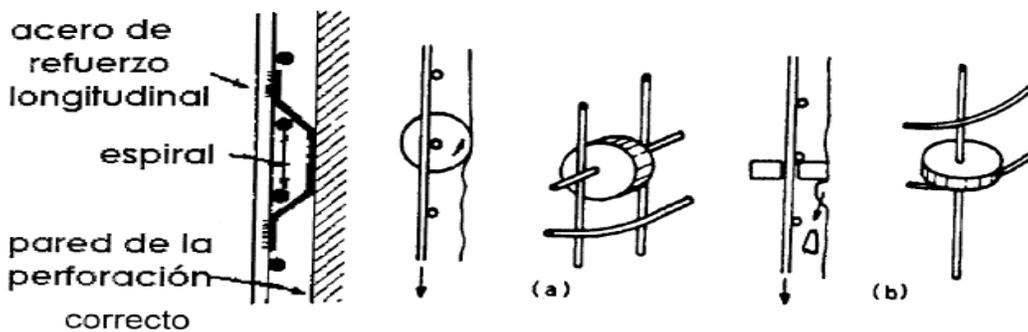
Elementos espaciadores para recubrimiento en pilas¹⁴
